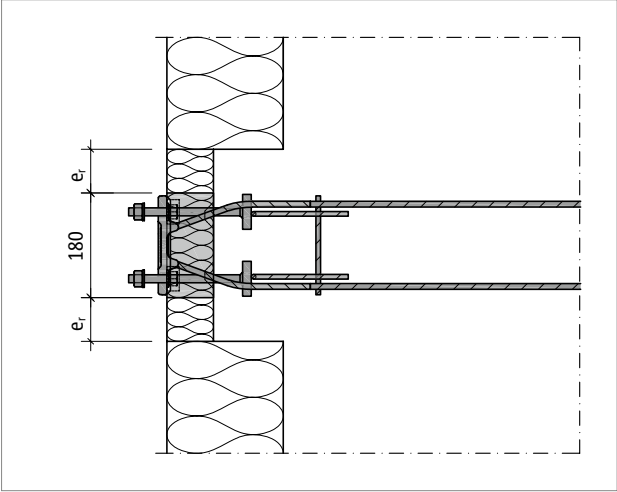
Schöck Isokorb® T type SQ : distances aux bords
